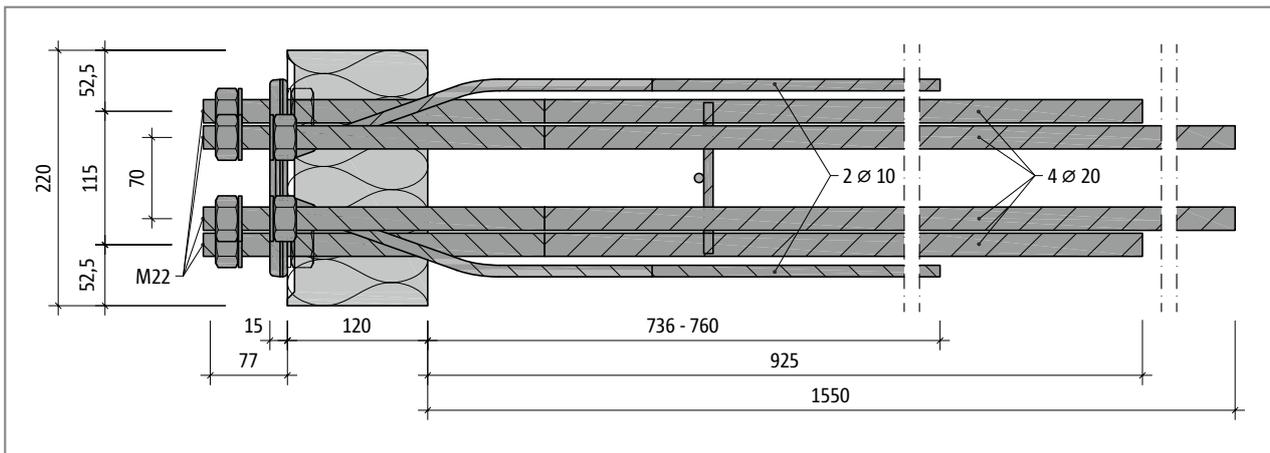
Schöck Isokorb® XT Typ SK-MM2-VV1: Grundriss
